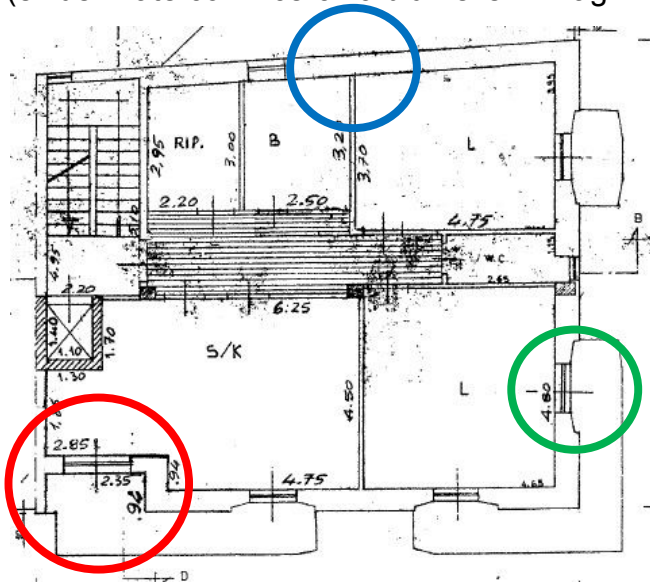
Planimetria allegata alla C.E. n. 390/2002
